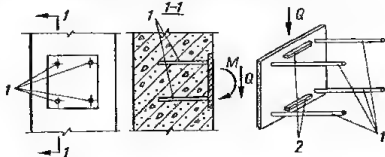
Конструкция закладной детали с анкерными стержнями, приваренными к пластинкам в тавр: 1 — анкерные стержни; 2 — упорные пластины.
